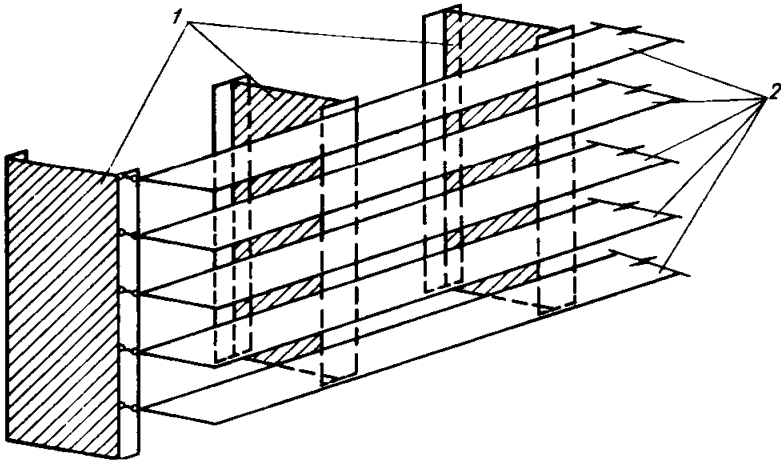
Перекрестная расчетная схема объемно-блочного здания
